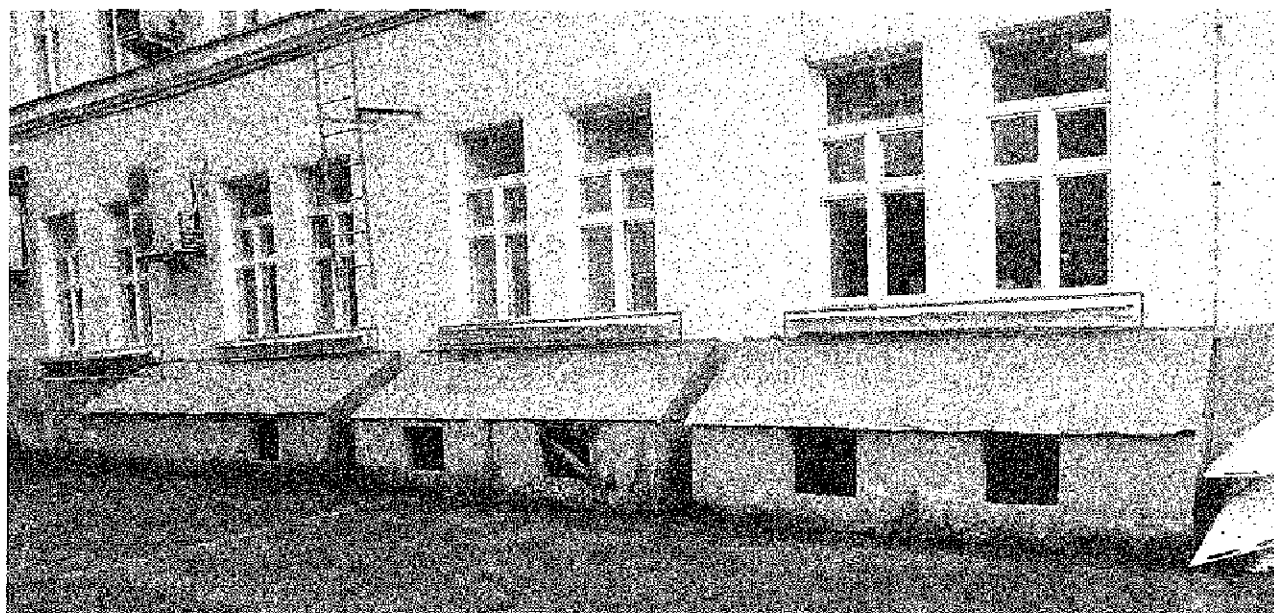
Профилированные подоконные карнизы, 1-й этаж. Западная часть северного фасада здания. Дата: 14.07.2021
